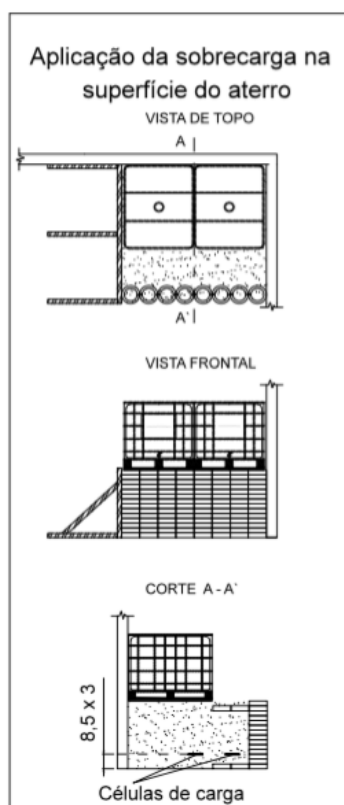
Faseamento construtivo com aplicação da sobrecarga.
